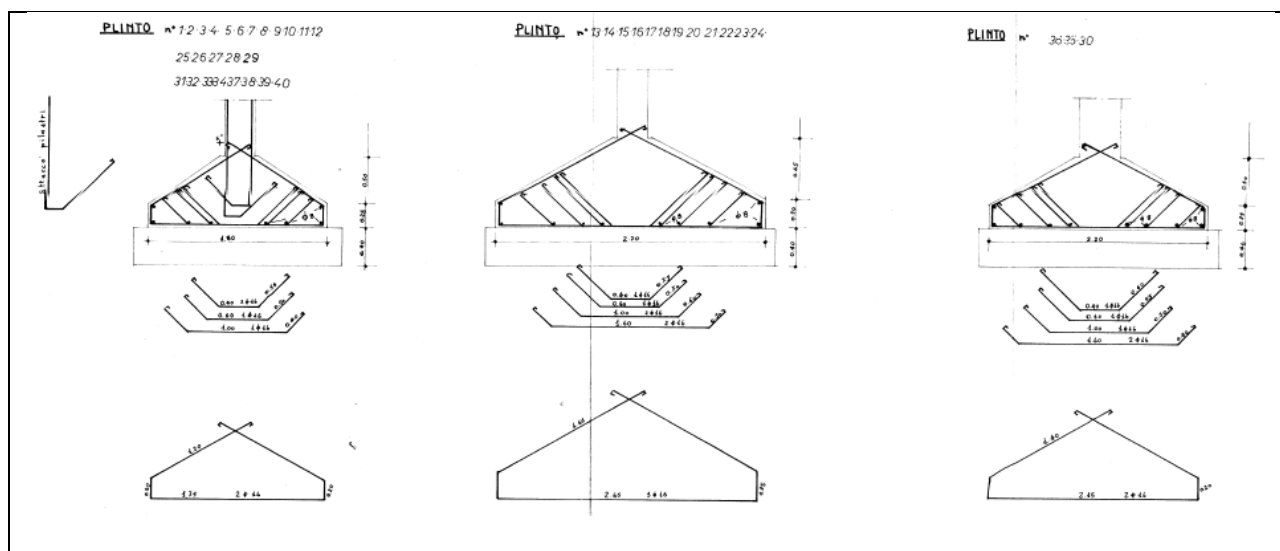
Stralcio delle tavole originali contenente dimensioni e armature dei plinti
